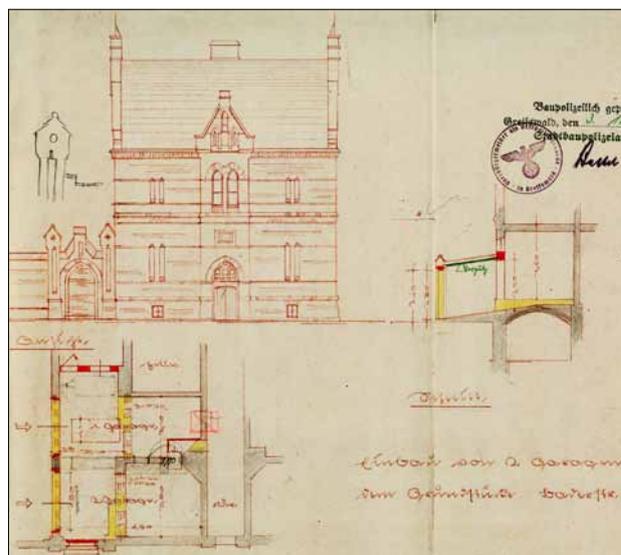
Greifswald, Baderstraße 24. Planung aus dem Jahr 1936 für den Einbau zweier Garagen im nordöstlichen Erdgeschossbereich des Gefängnisgebäudes und im rückwärtig angrenzenden Hof: gelb = abgängig, rot = Neubau. Abbildung: Bauamtsakte: Baderstraße 24
